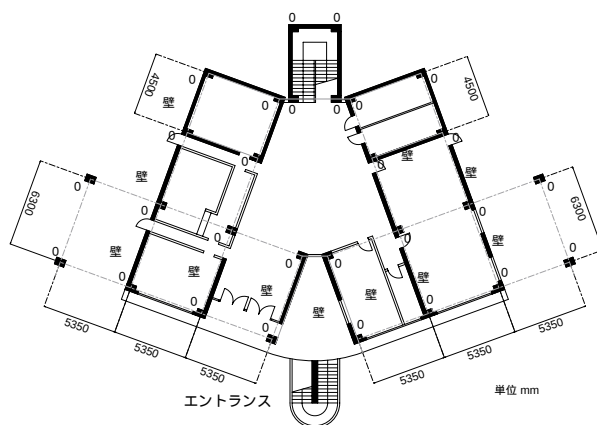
：若郷小学校 1 階の平面図と柱・耐震壁の損傷度
